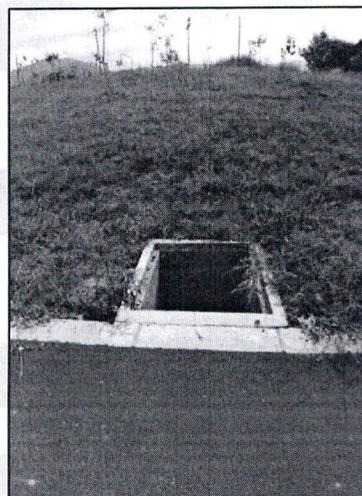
Instalar las tapas de cajas hidráulicas de inspección via 1 k0+260
